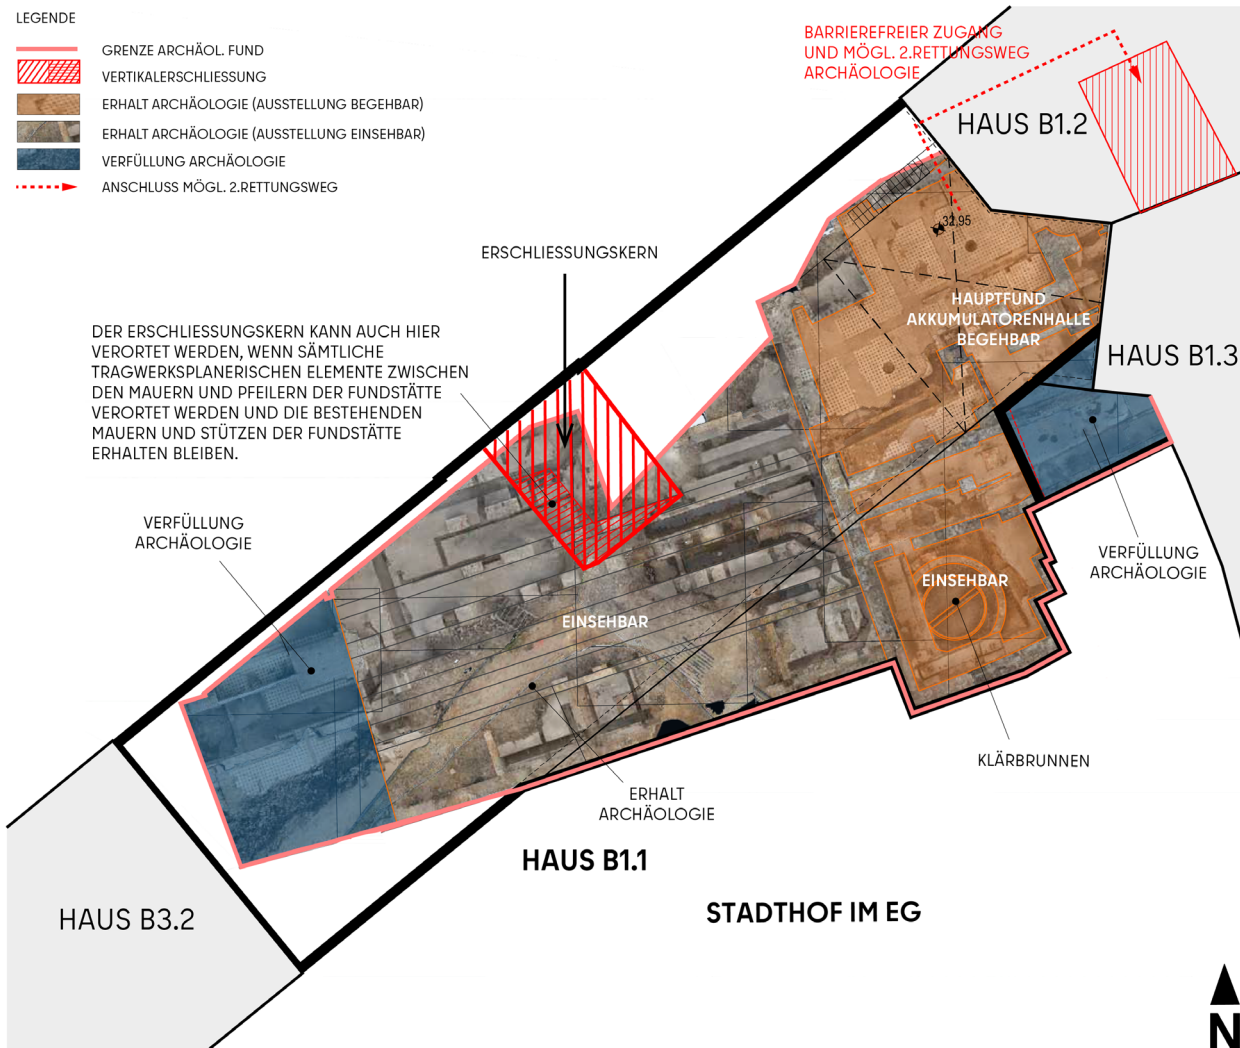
Schematischer Grundriss Untergeschoss
